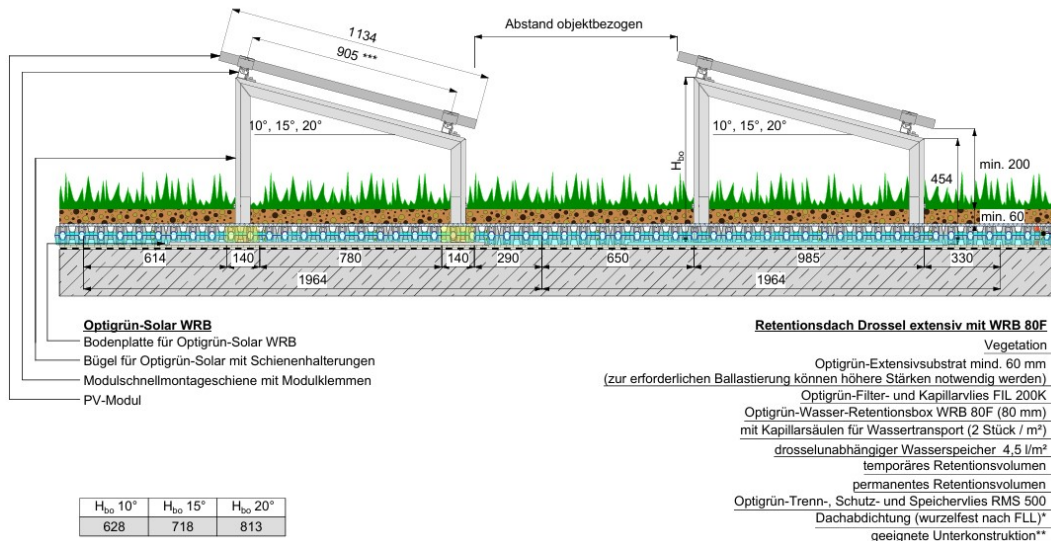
Gründach mit Retentionsdachaufbau und Photovoltaikpanelen, Beispiel
